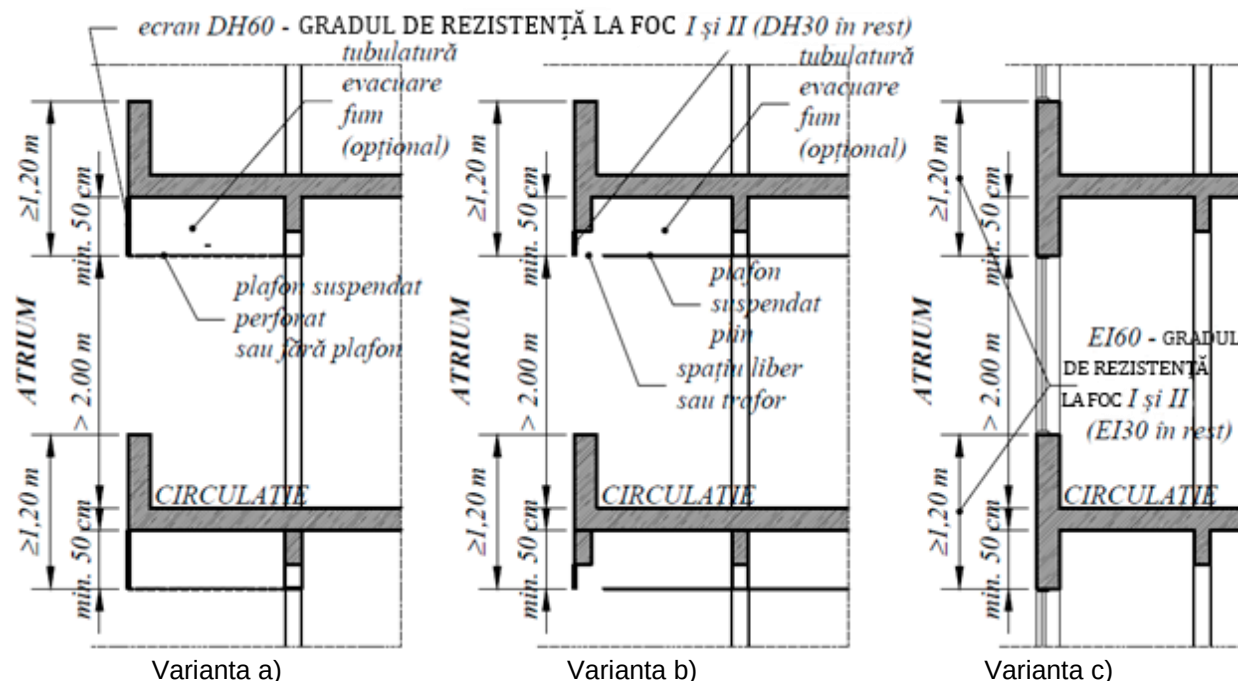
Circulațiile orizontale comune, deschise (variantele a și b) și închise (varianta c)
